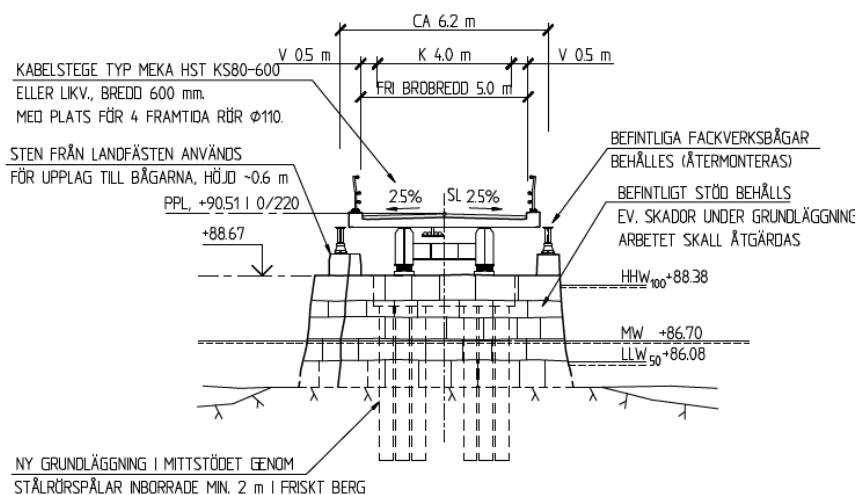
Elevationsritning på Kirunabron (Sarvell, 2013).
